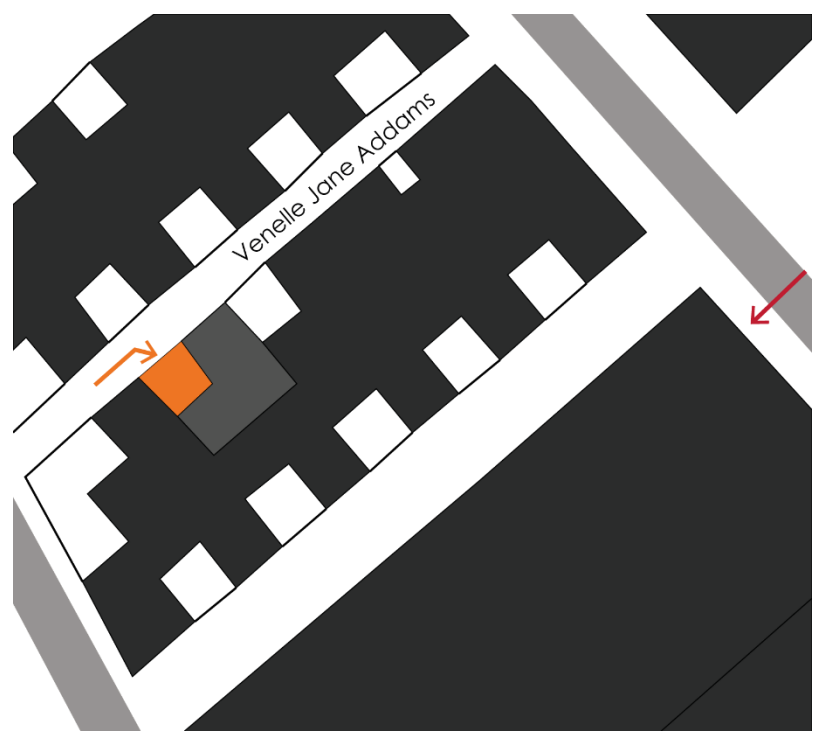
Plan zoom sur la venelle Jane Addams, Mai 2020, Victoria HENIN
